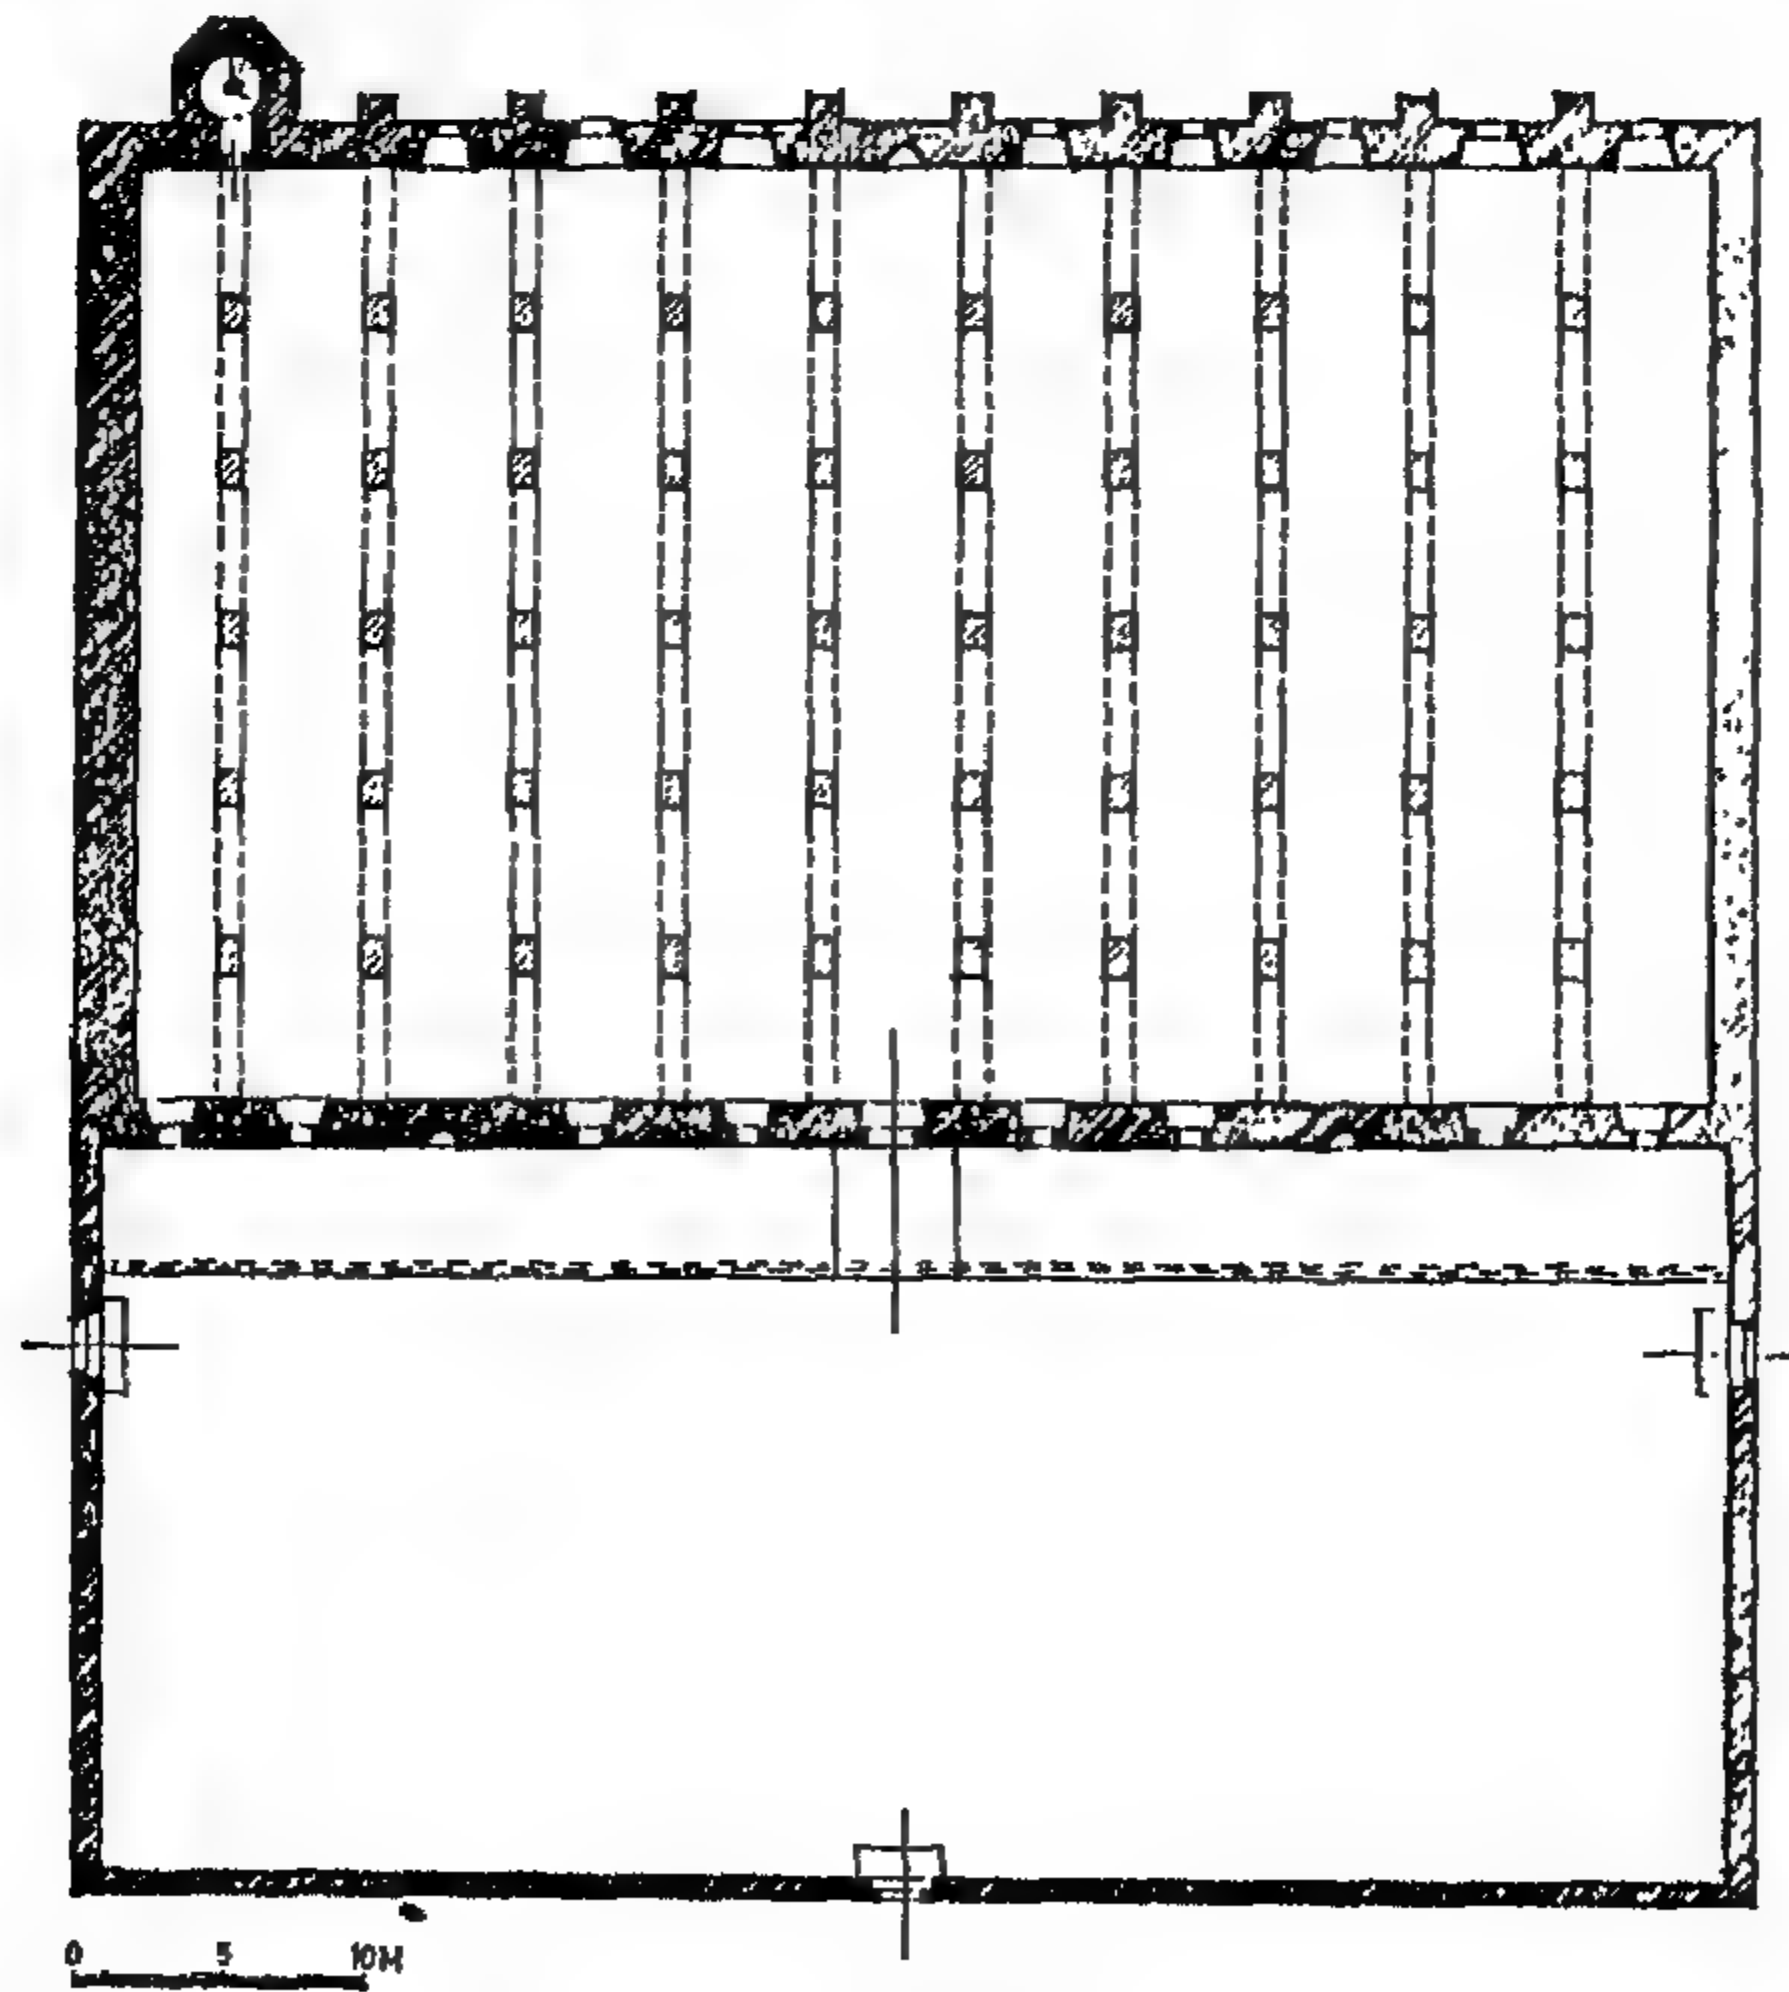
مسقط أفقي لمسجد Gunmant
